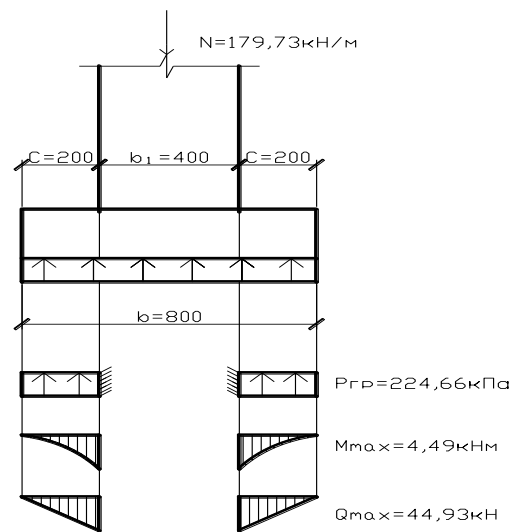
До розрахунку тиску під стрічковим залізобетонним фундаментом
